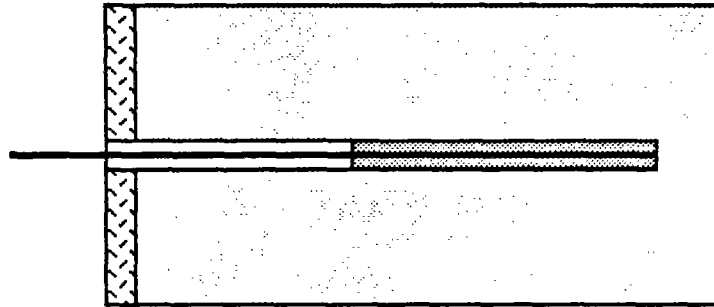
Schéma d'un clou en place dans le premier type d'essai d'arrachement.
